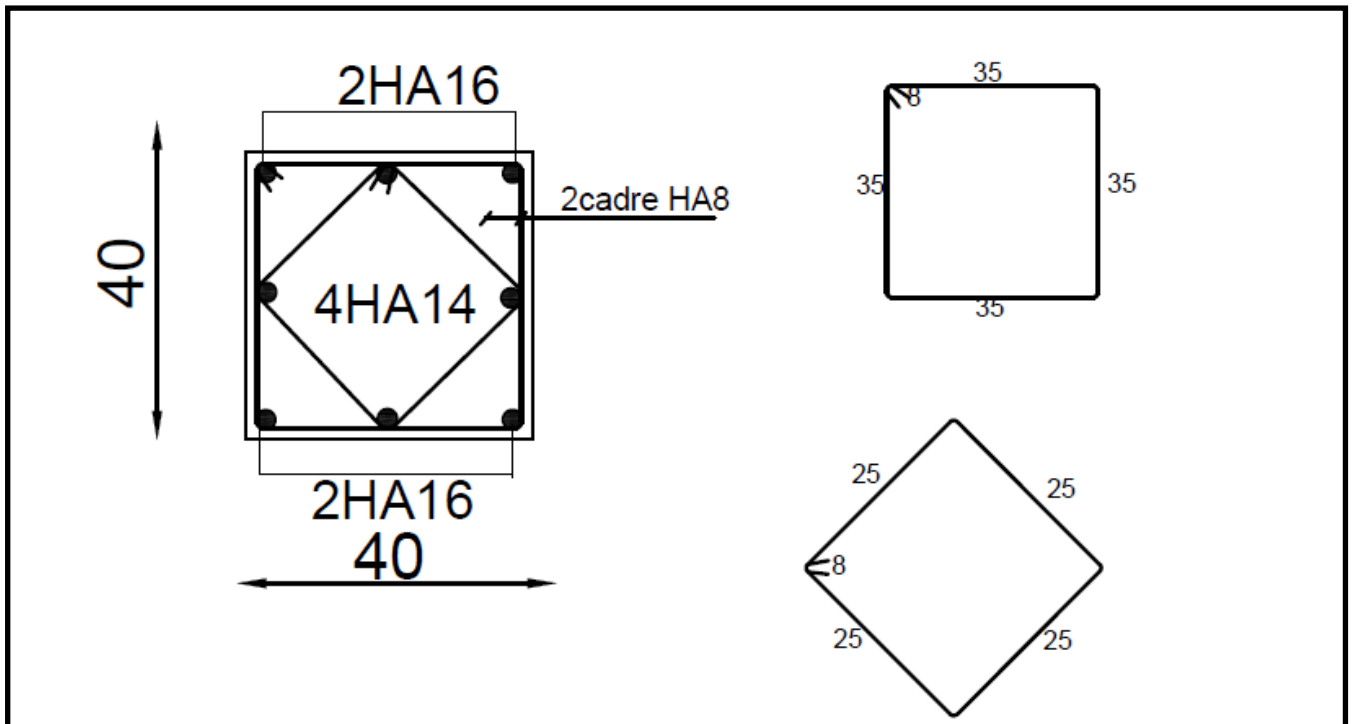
Ferrailage Poteau 45x45
